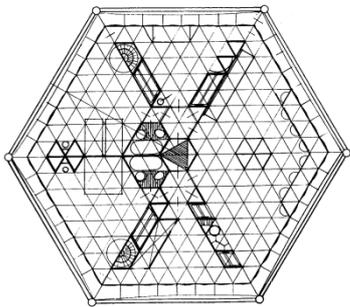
Esquema de ventilação e planta 'Wichita house', RBF, 1944
